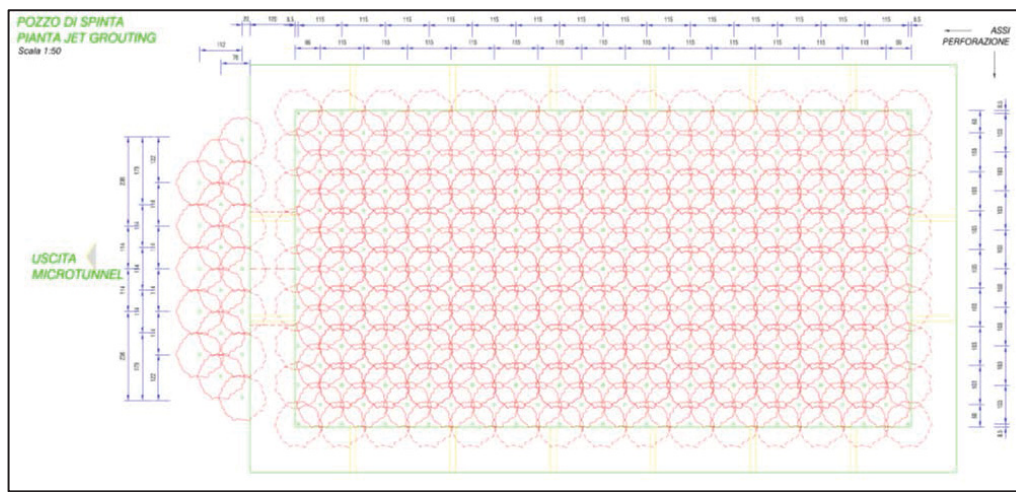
/B - Schema del progetto di un “tappo di fondo” con colonne compenstrate di jet grouting
